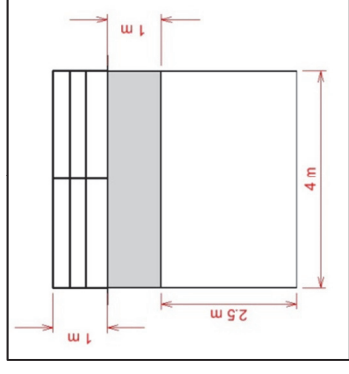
Estructura M11, culvert accés a vial no asfaltat, sobre la riera Gavarra.
